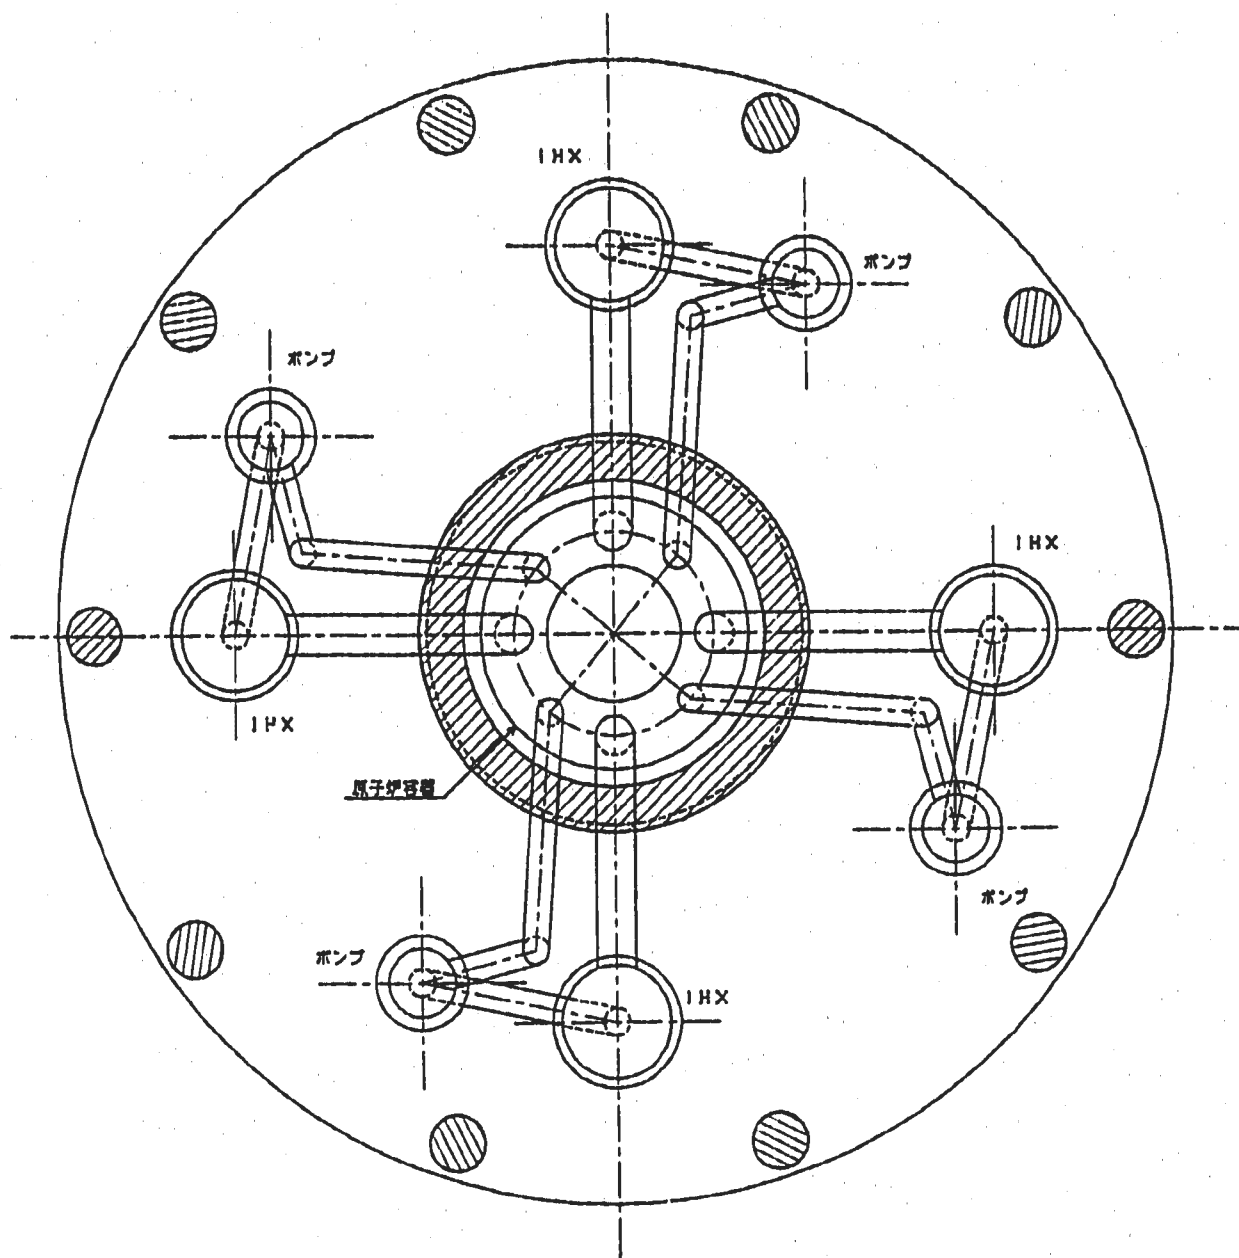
皿ばね平面配置図 (ケース4 : デッキ外周の皿ばねがφ2000mmの場合)
